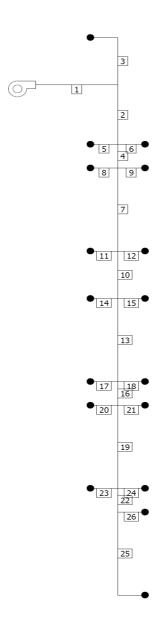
Distribución ramales Planta Tipo CL N-S
